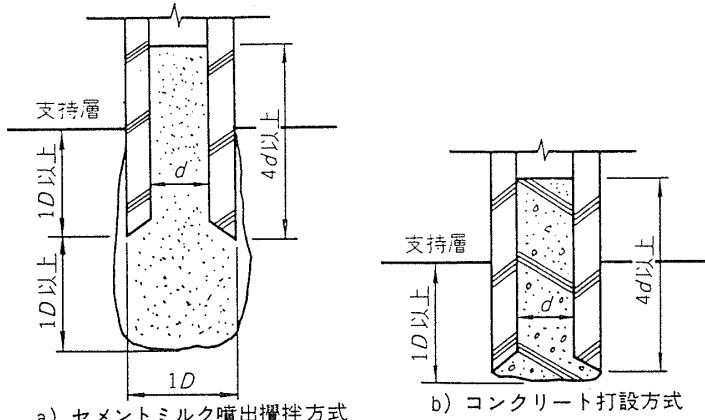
中掘工法の先端処理 ¹⁴⁸⁾
